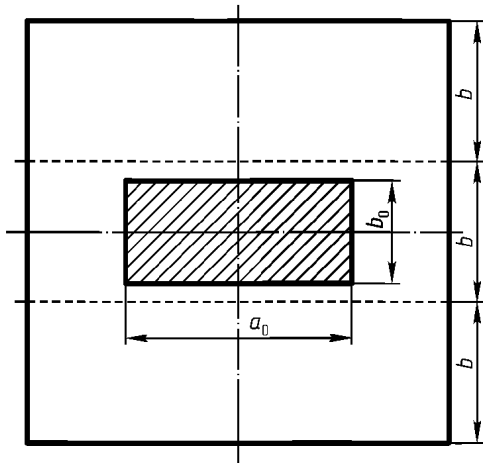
Схема расположения пятна нагрузки на палубе
